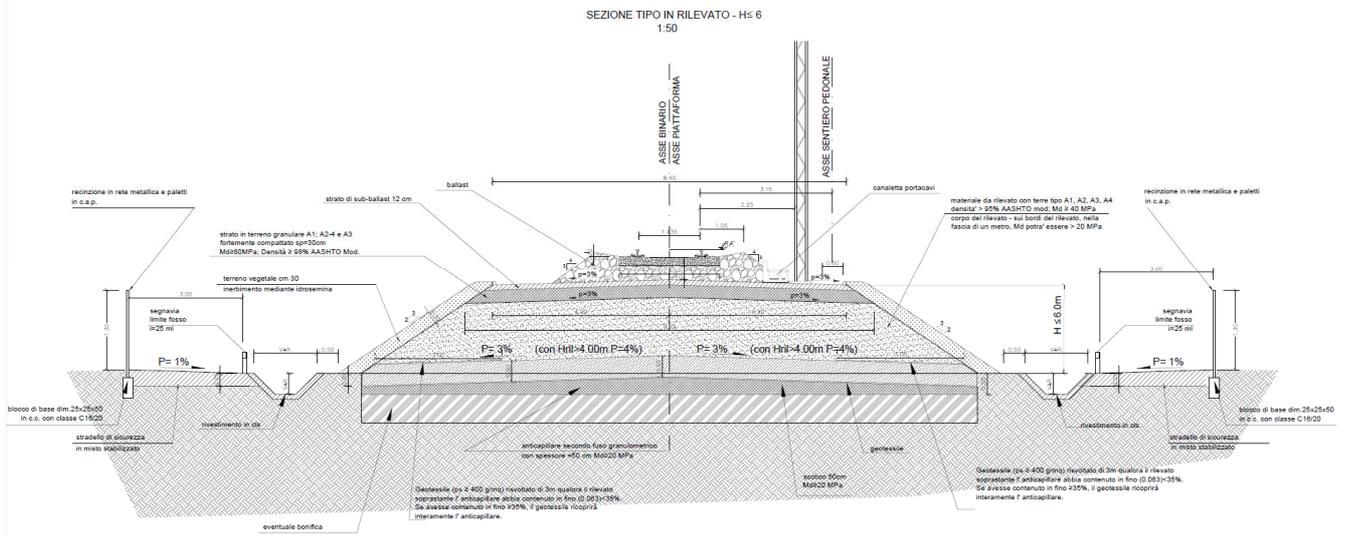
Sezione tipo in rilevato a SB, $H \leq 6.0$ m
